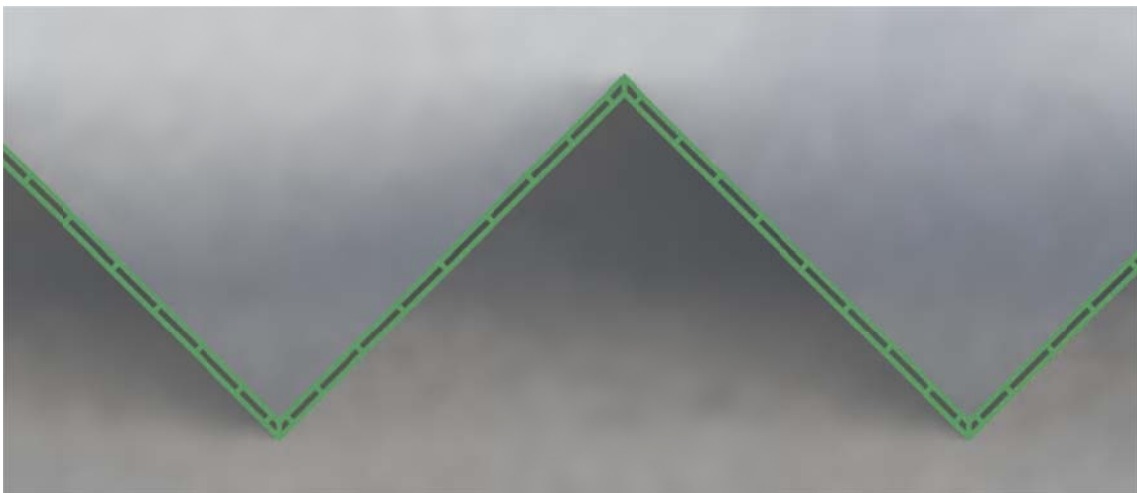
Detalle de panel en planta con la cámara incorporada. (Fuente: Elaboración propia)
